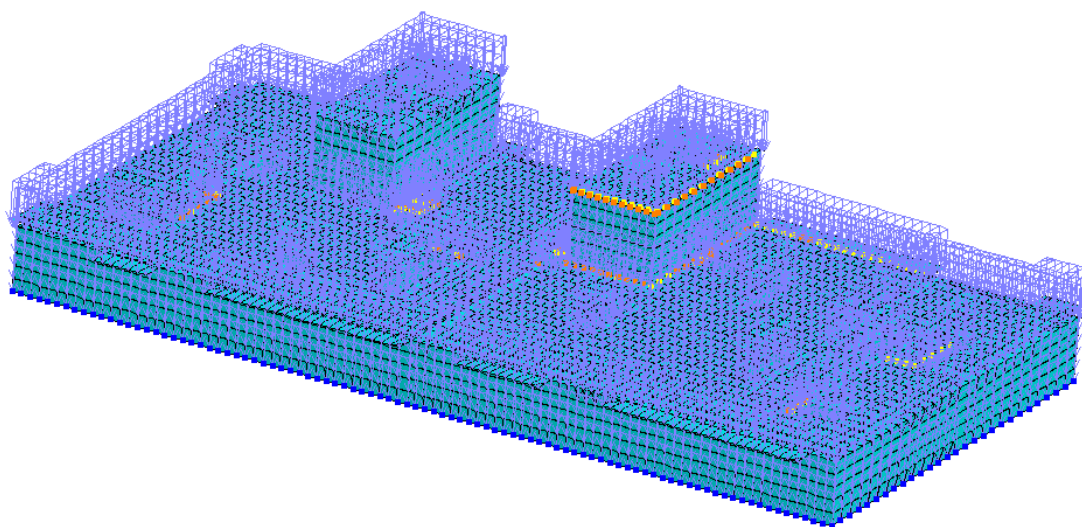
Расчетная схема плиты покрытия с нагрузкой от собственного веса элементов железобетонных конструкций
